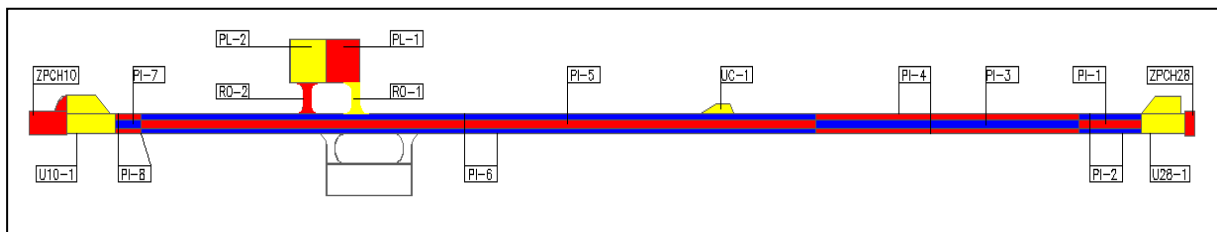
Plano esquemático secciones del Aeropuerto Mataverí.
